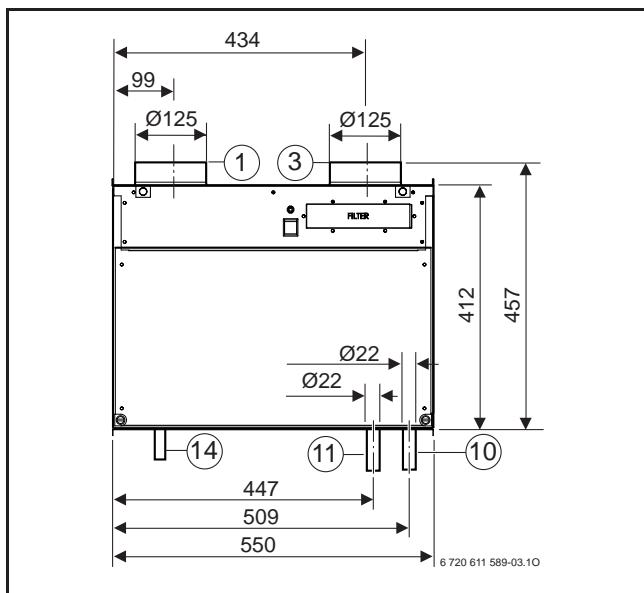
Bau- und Anschlussmaße (Maße in mm)
